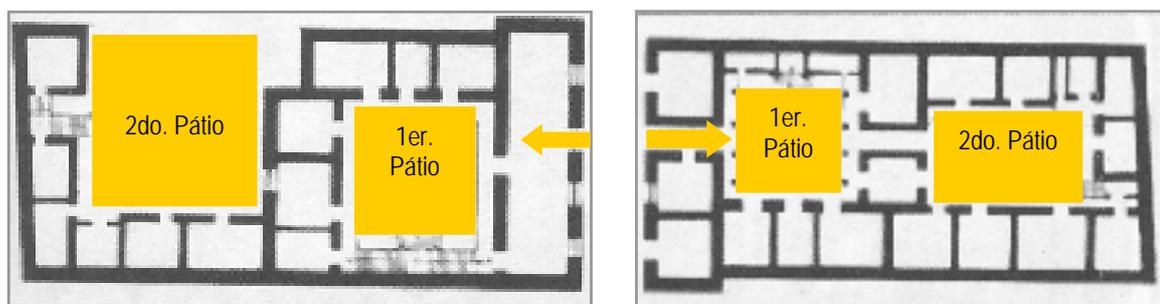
Plantas - Casa de altos ou casa de dois Pavimentos.
